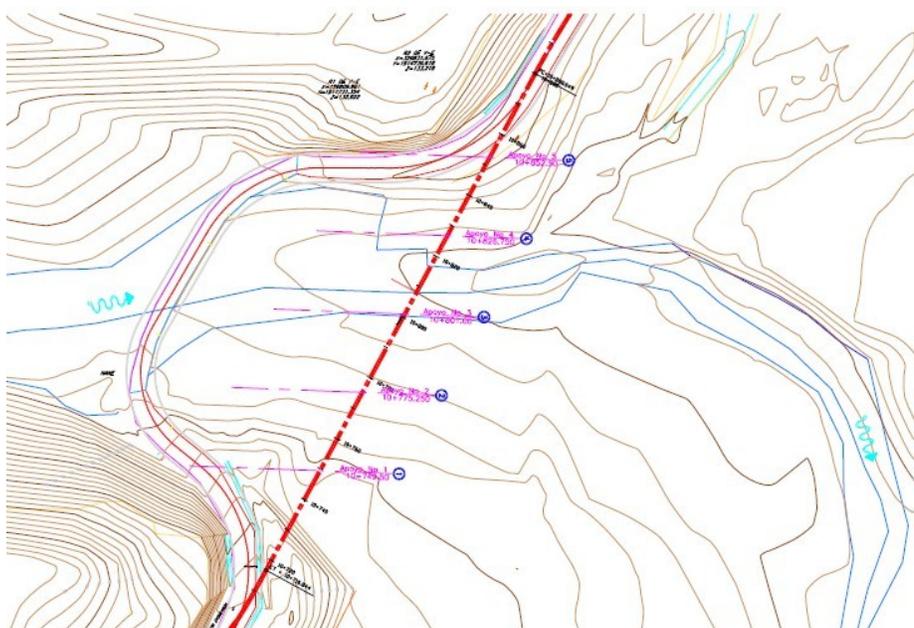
Ubicación de los apoyos para la construcción del puente Corinto.
